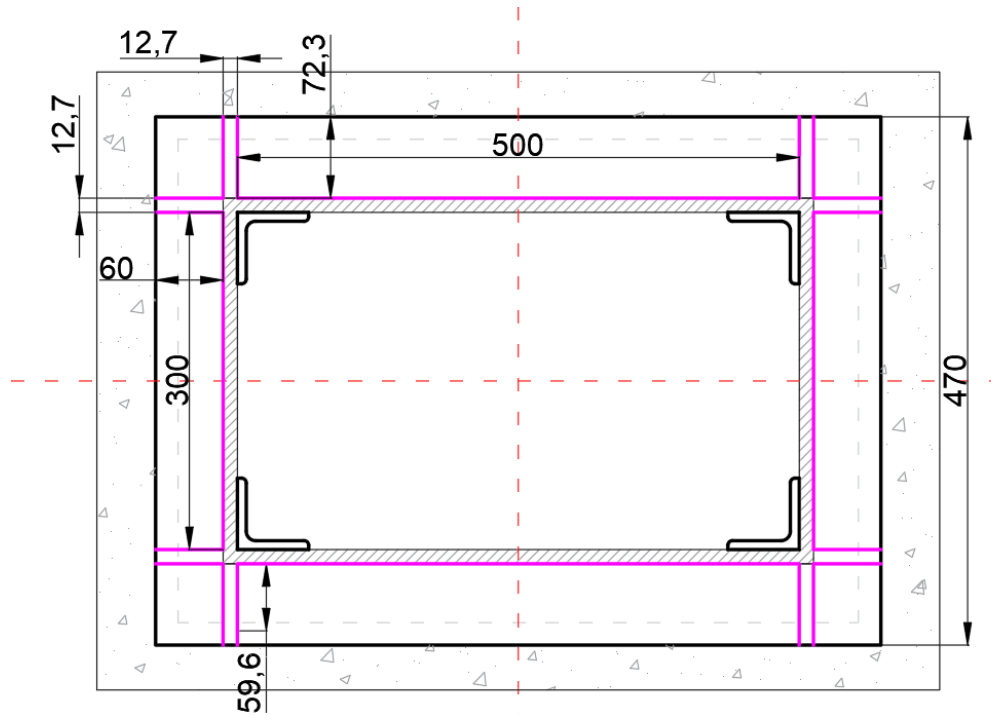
Esquema de soldadura entre presilla y placa base de la columna metálica
